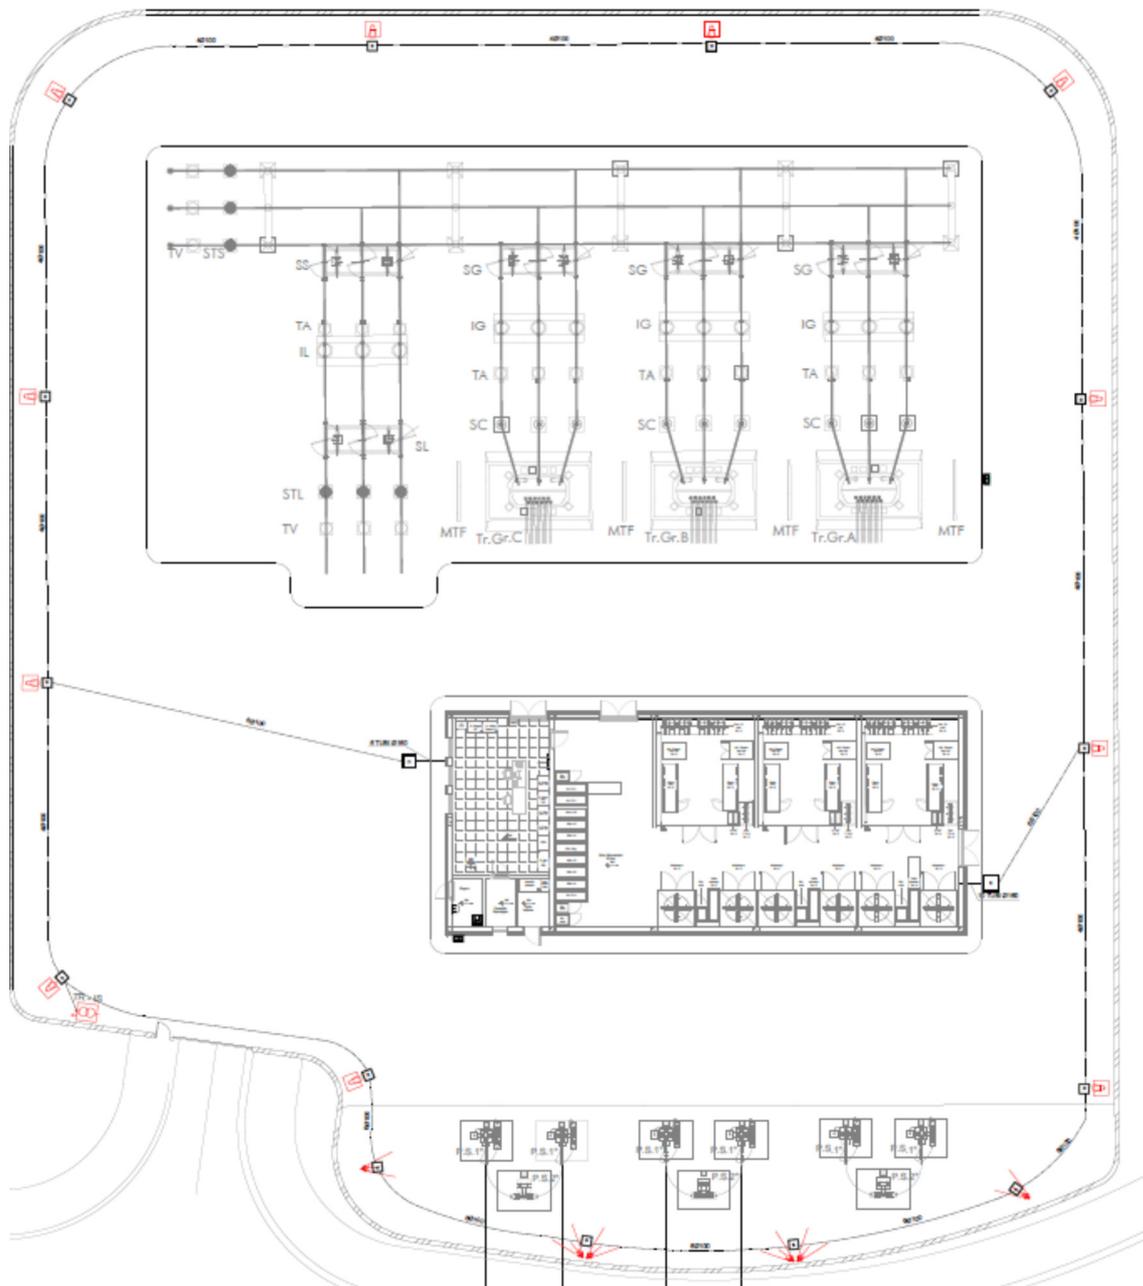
Planimetria impianto luce e forza motrice del piazzale
